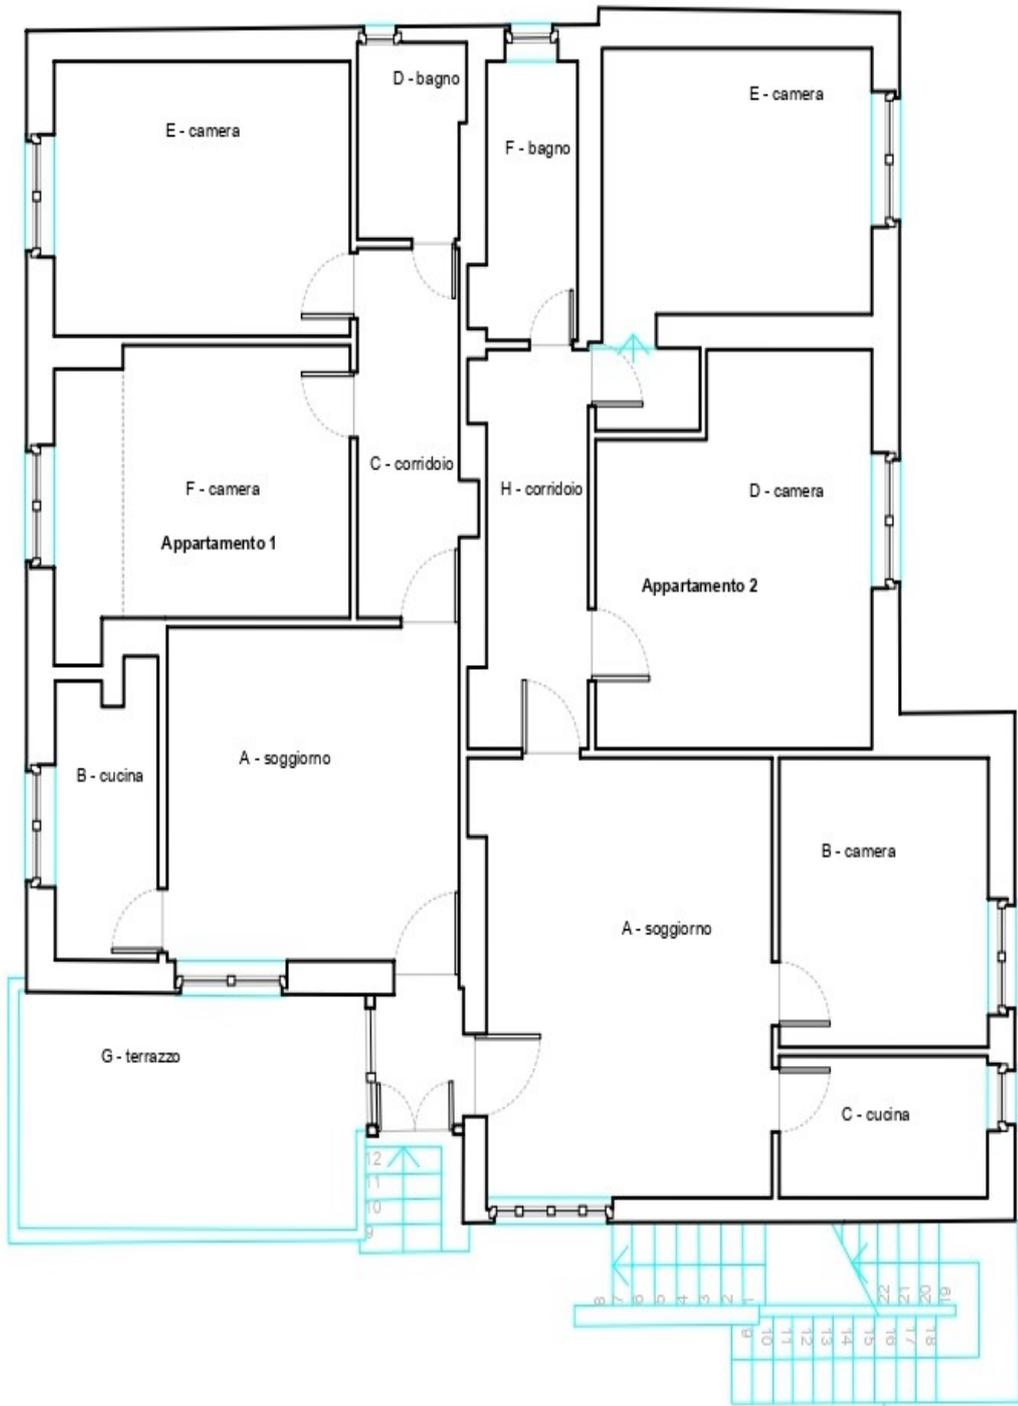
Planimetrie unità immobiliari. Piano rialzato.
